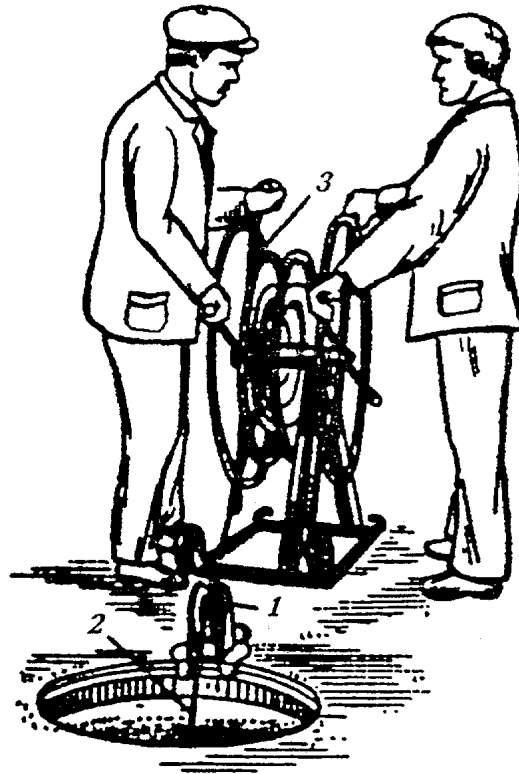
Вытяжка заготовочной проволоки из выходного колодца.
